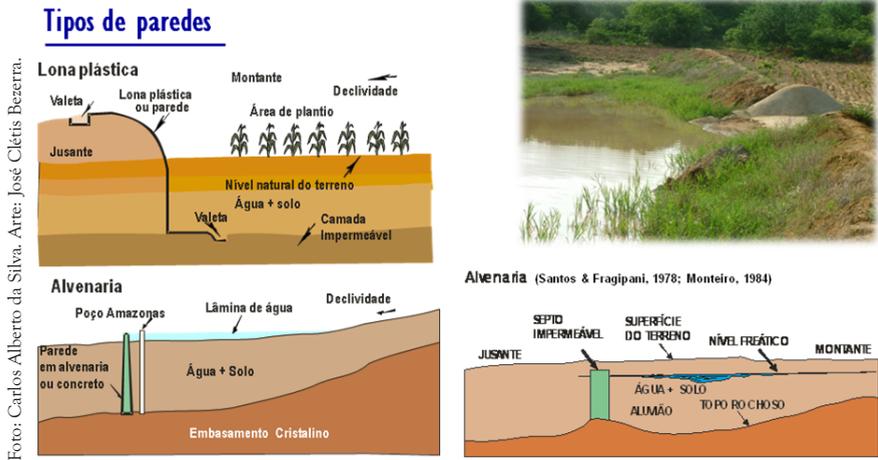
Tipos de paredes de barragem subterrânea construída com lona de polietileno ou alvenaria.
